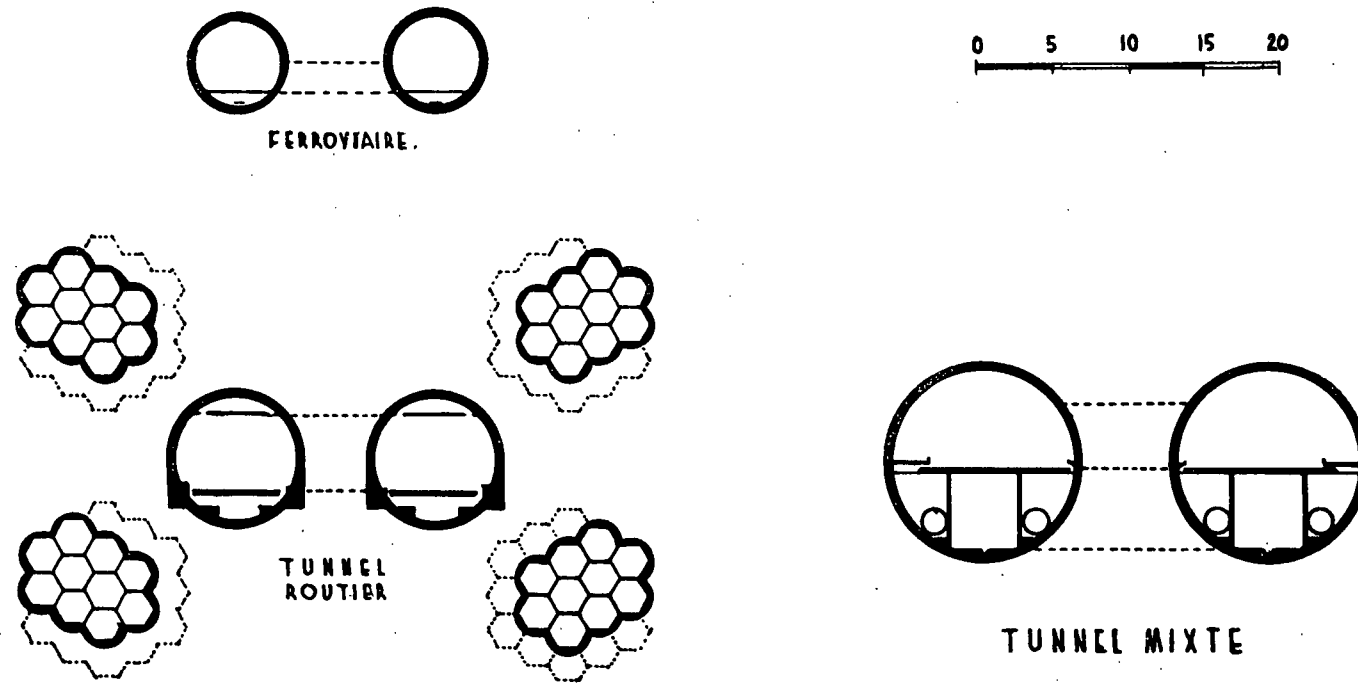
Comparaison des divers projets (sauf le tunnel mixte 1948)
